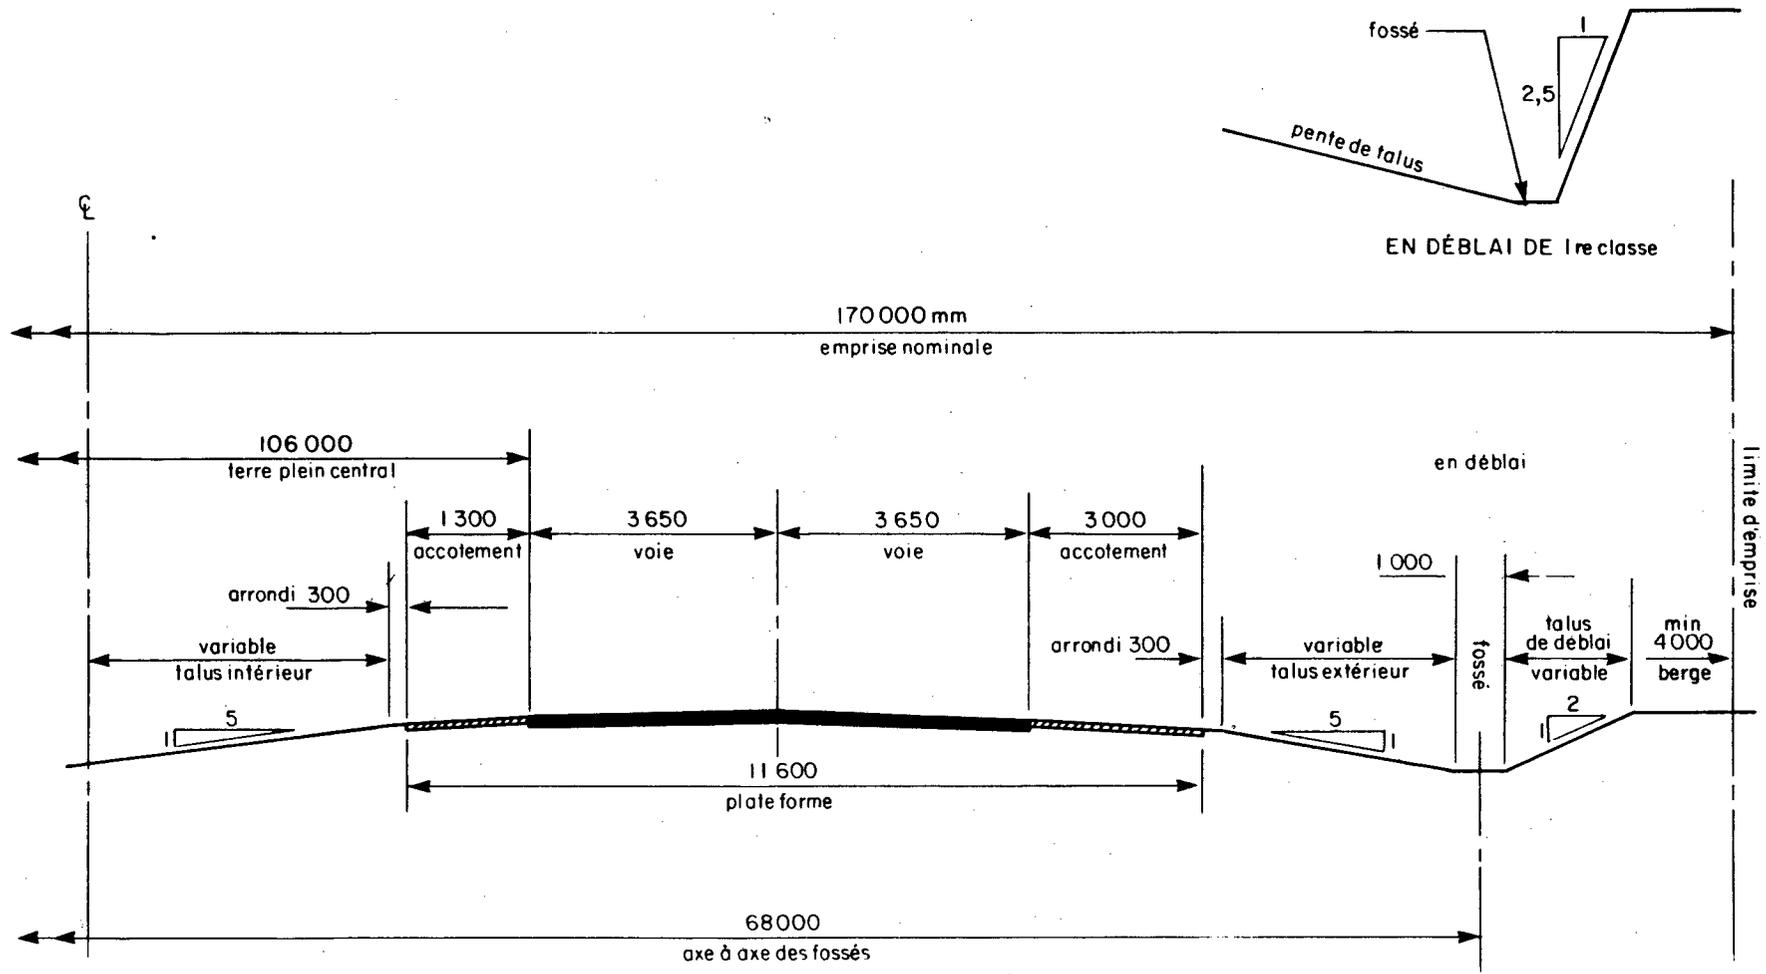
Profil en travers de l'autoroute à deux chaussées
